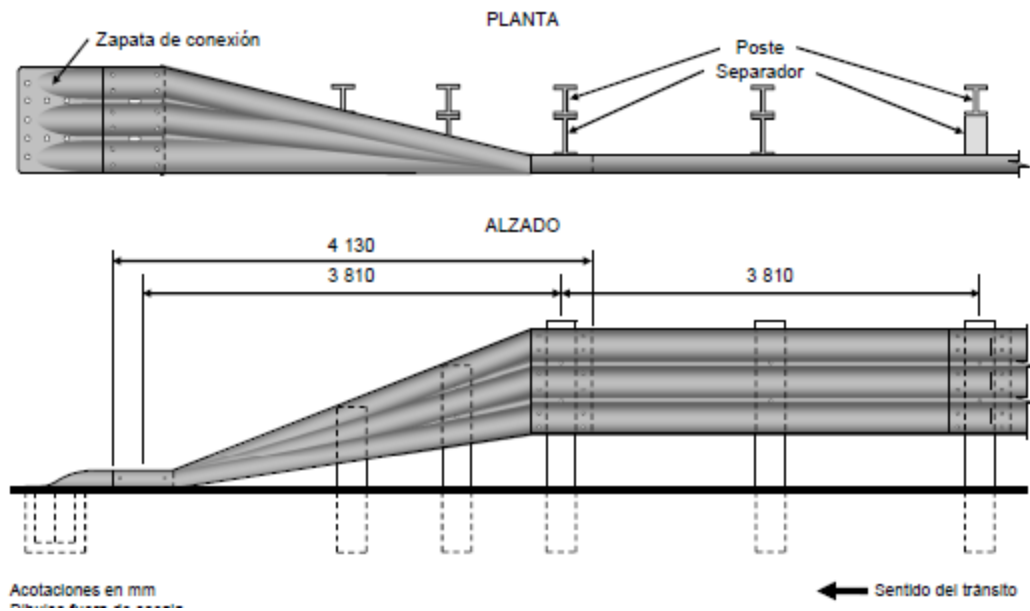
Sección terminal aterrizada para vigas acanaladas de dos y de tres crestas
